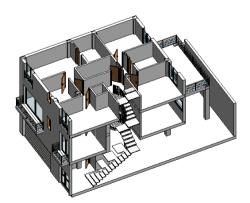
Carpintería interior y exterior. 2014. Elaboración propia.
